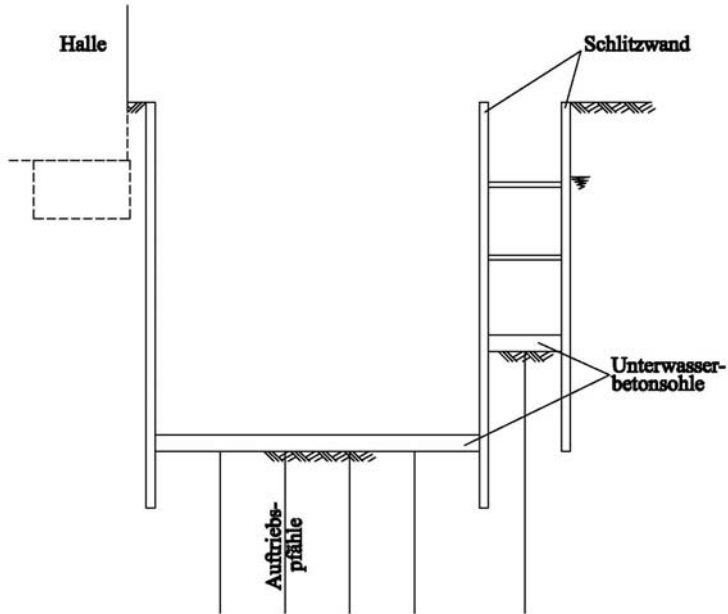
Schnitt durch Baugrube Sinterbrunnen und Pumpenraum
